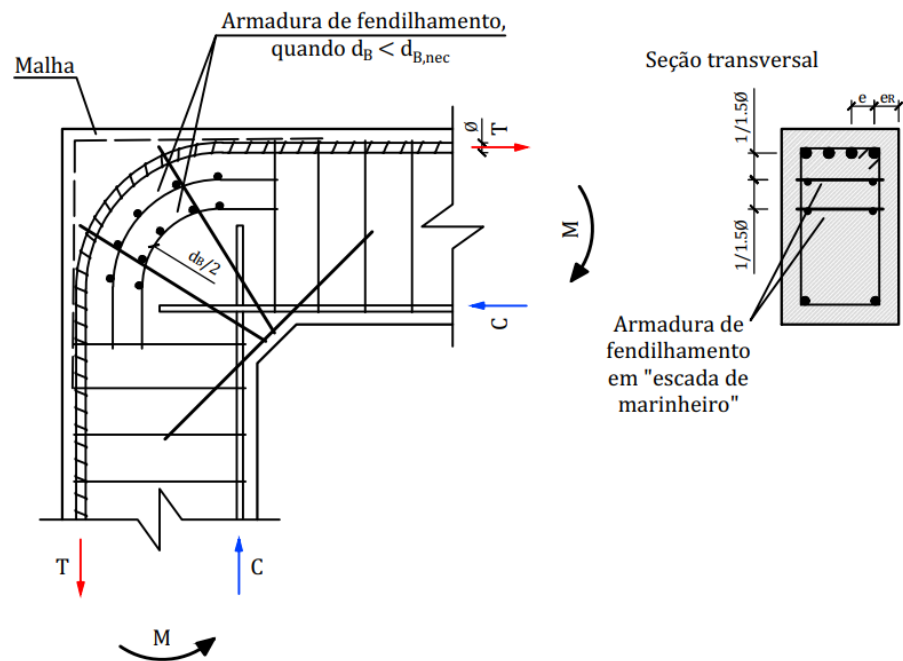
Detalhamento da armadura de um nó de pórtico.
